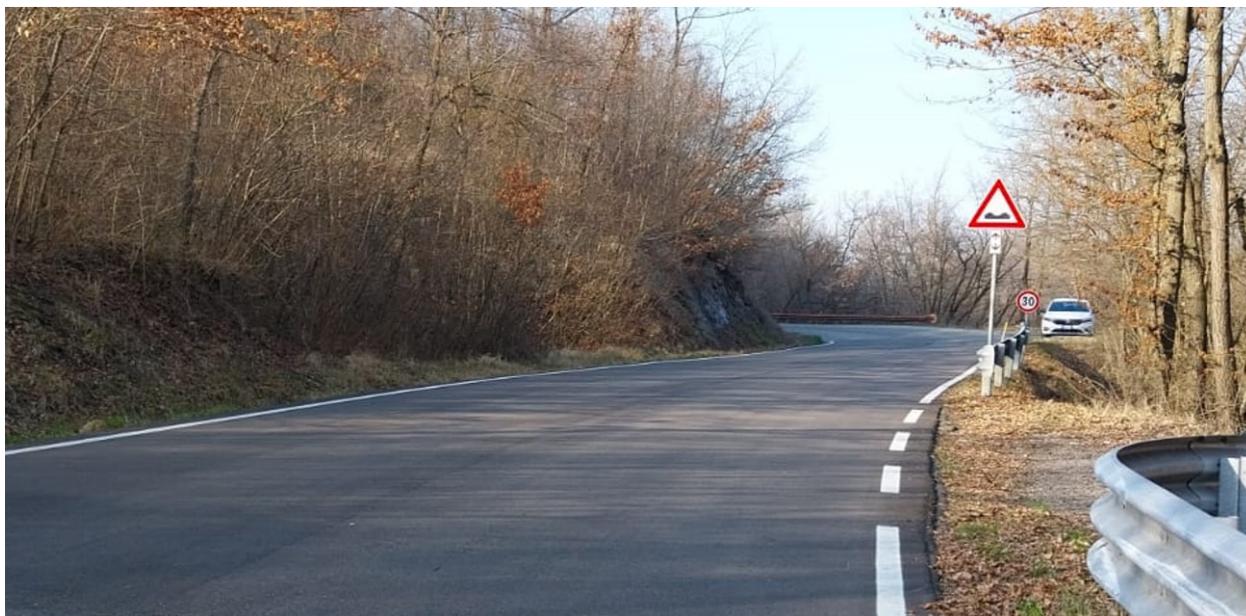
vista tratto stradale adiacente il muro e la barriera oggetto di intervento
